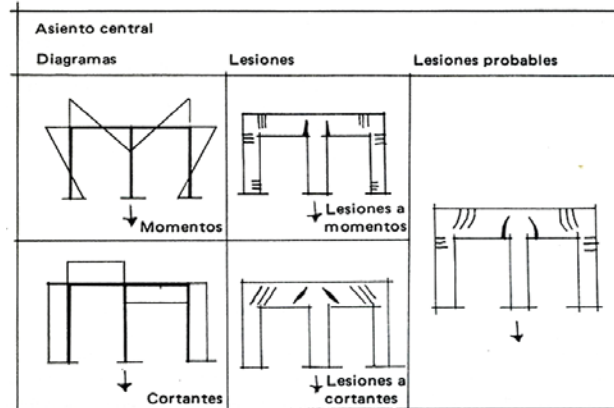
Esfuerzos generados por el movimiento y la situación de las fisuras en un pórtico de hormigón armado de dos vanos en el supuesto de asentamiento central.
